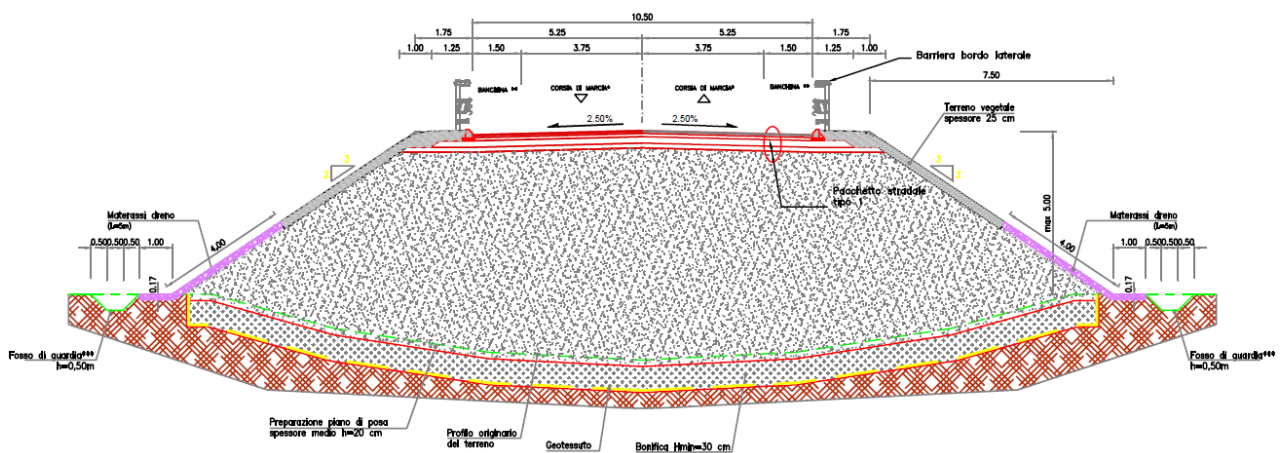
Sezione tipo del rilevato e protezione di 5m con materassi Reno su geotessuto
